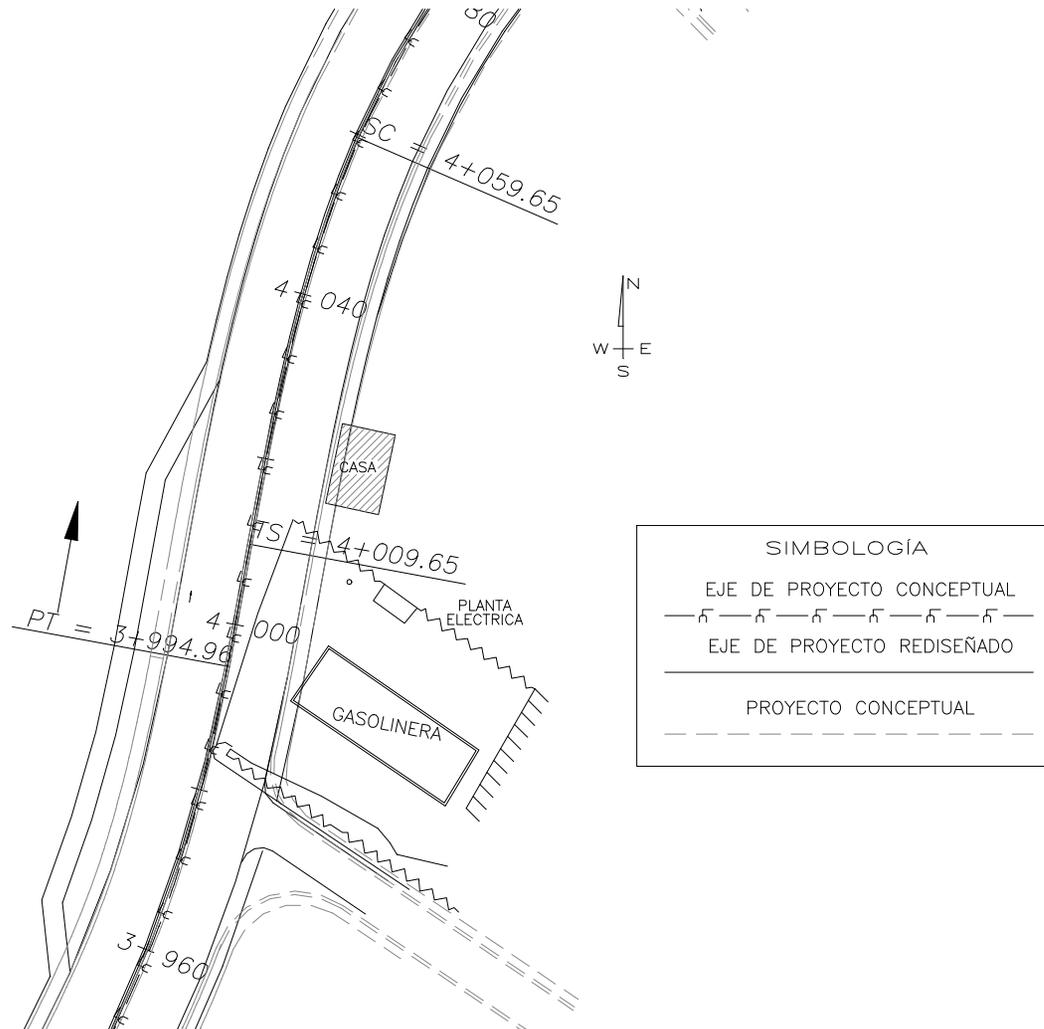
AFECTACIÓN DE GASOLINERA EN EL PROYECTO ADAPTANDO EL EJE PROYECTADO AL EJE EXISTENTE.
